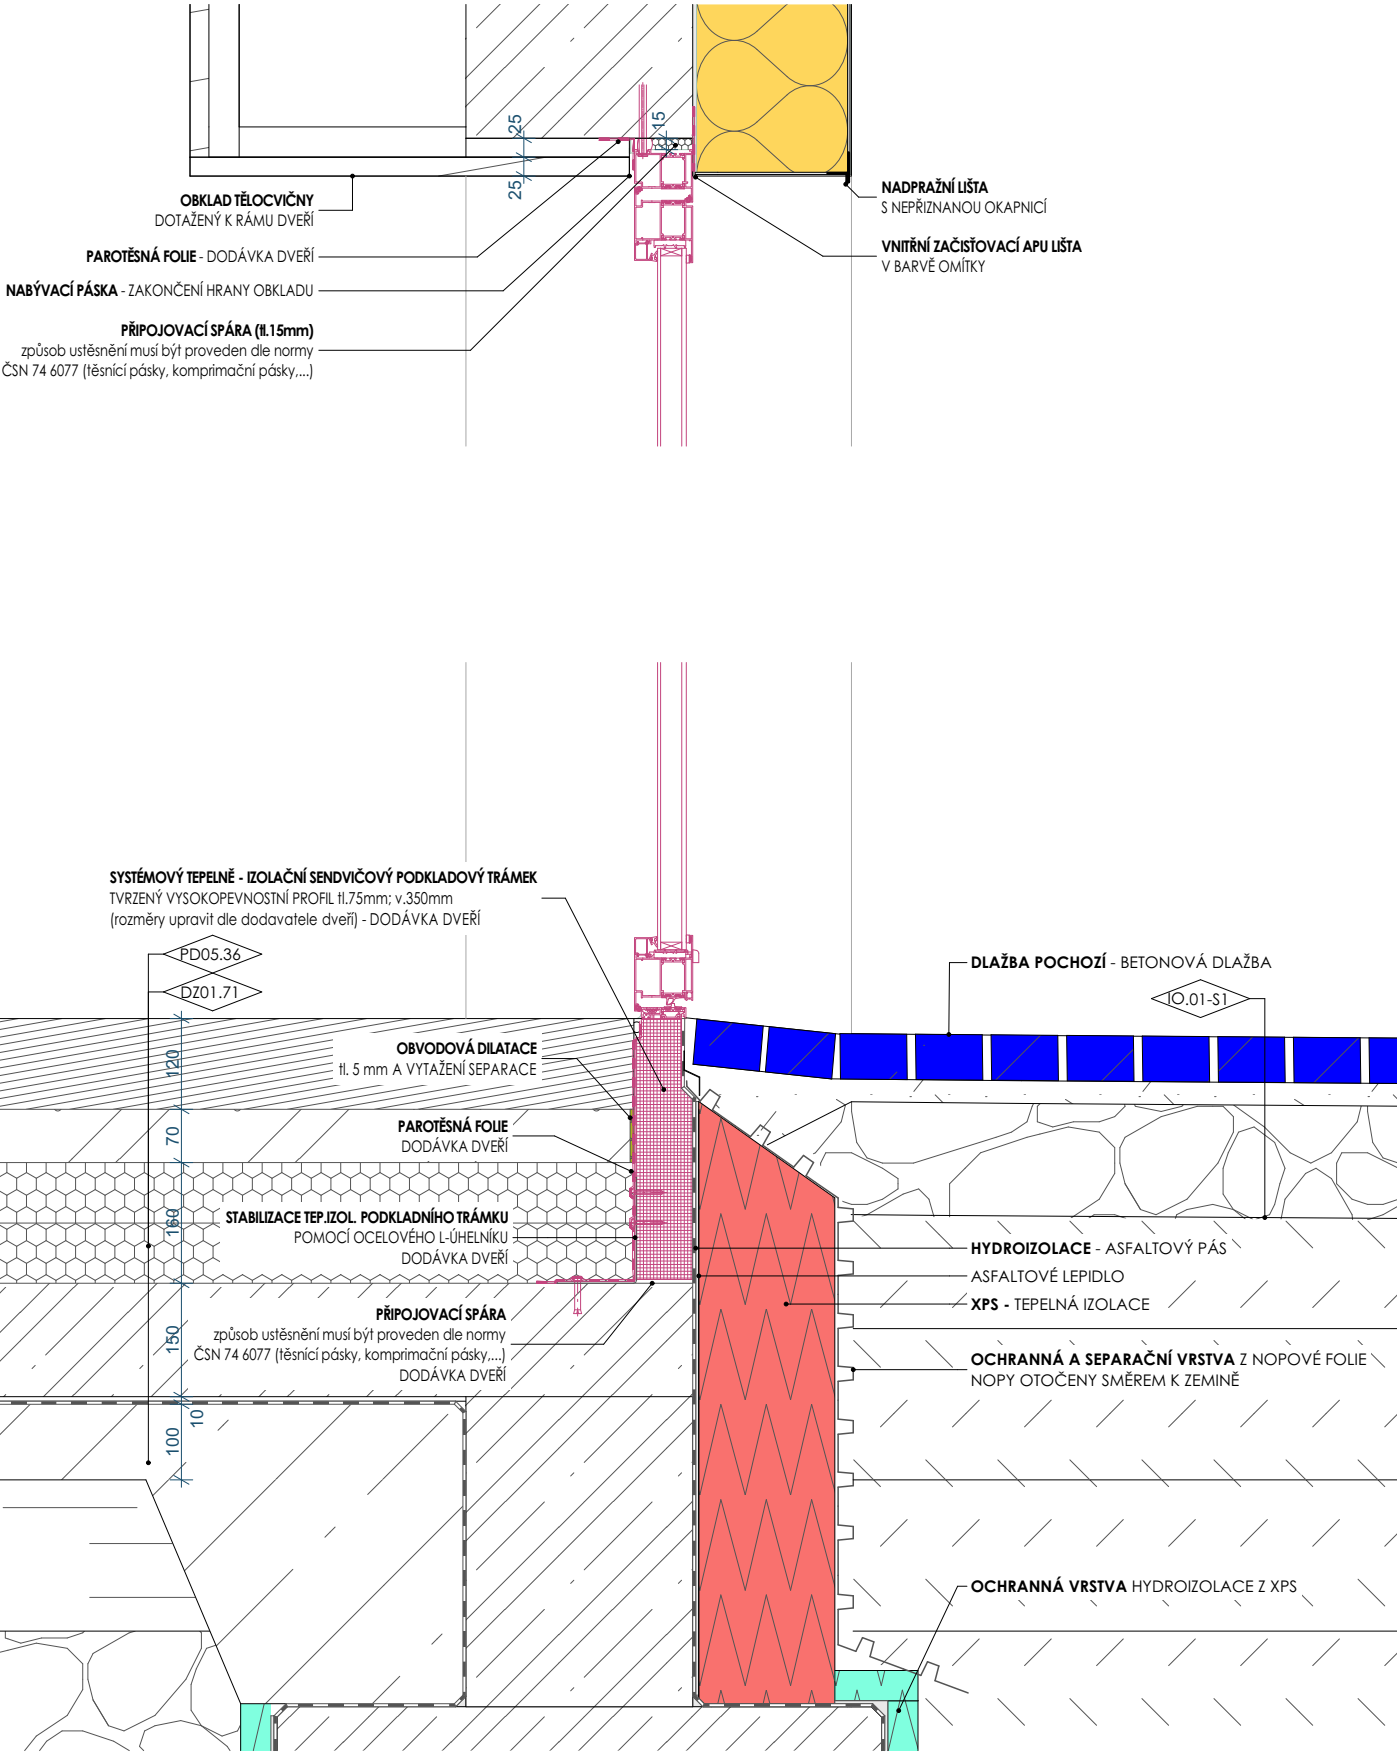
ŘEZ LOP - VÝTAH 1-2NP
